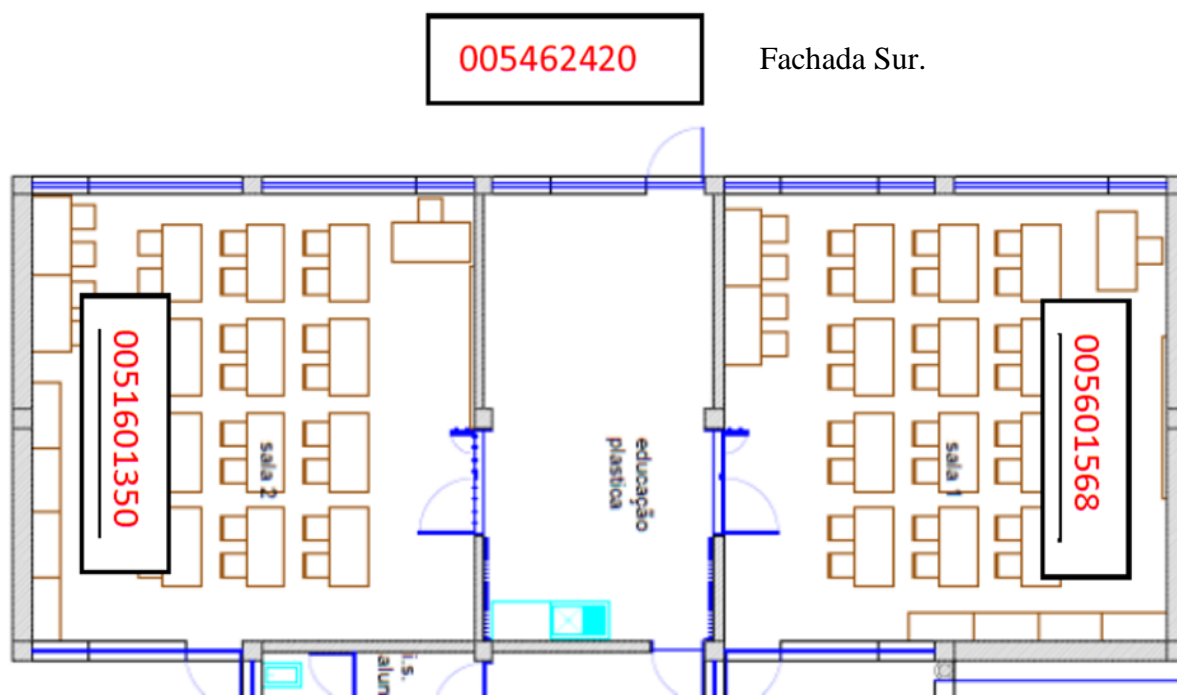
Sensores instalados en las aulas de la planta primera y el situado en el exterior en la fachada sur.
